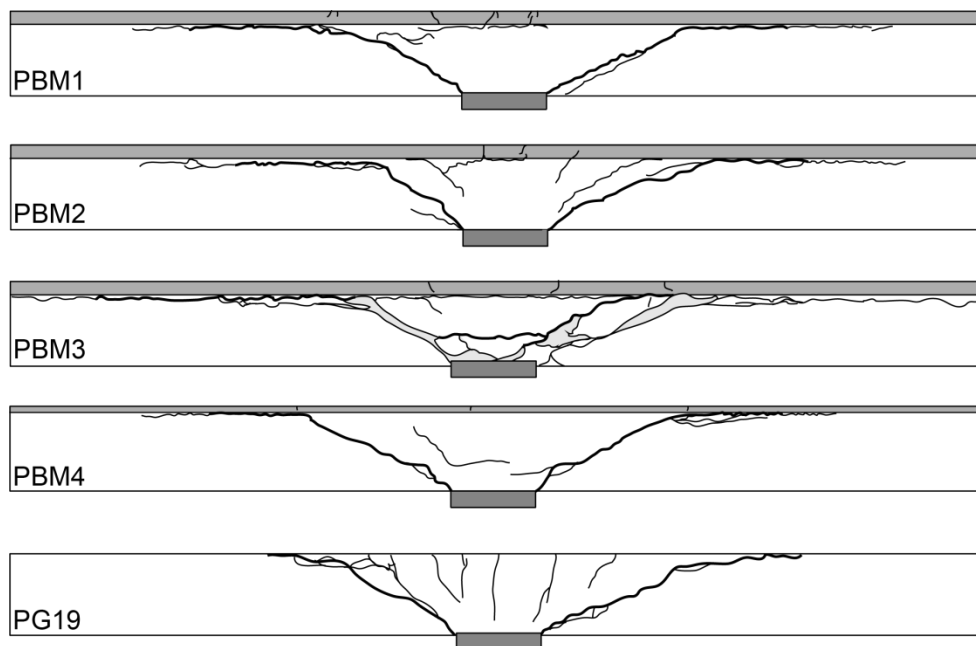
Patrons de fissurations sur l'axe central de la dalle
